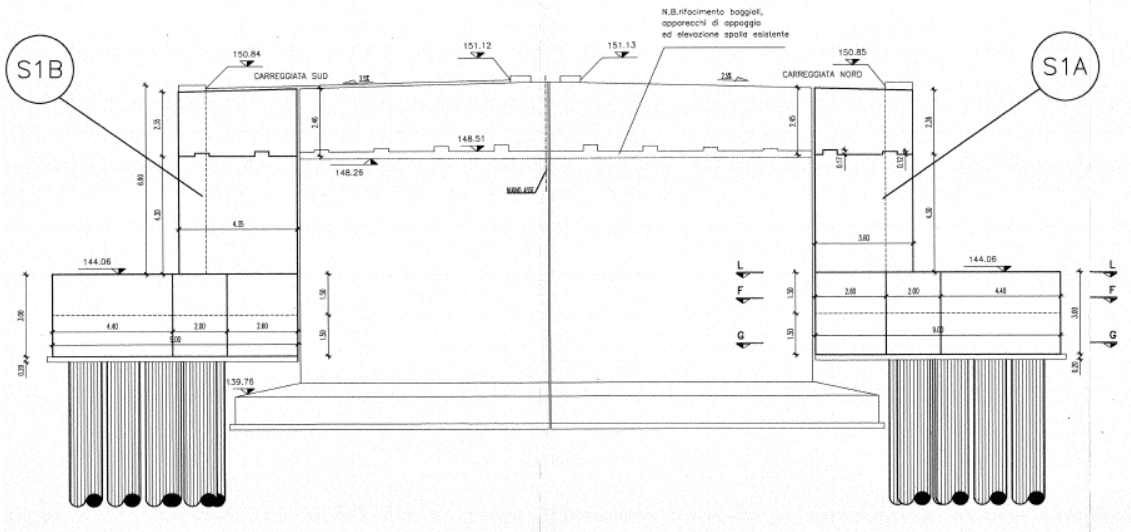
Ponte sul torrente Mavigliano, prospetto frontale spalla nord [004.pdf]
